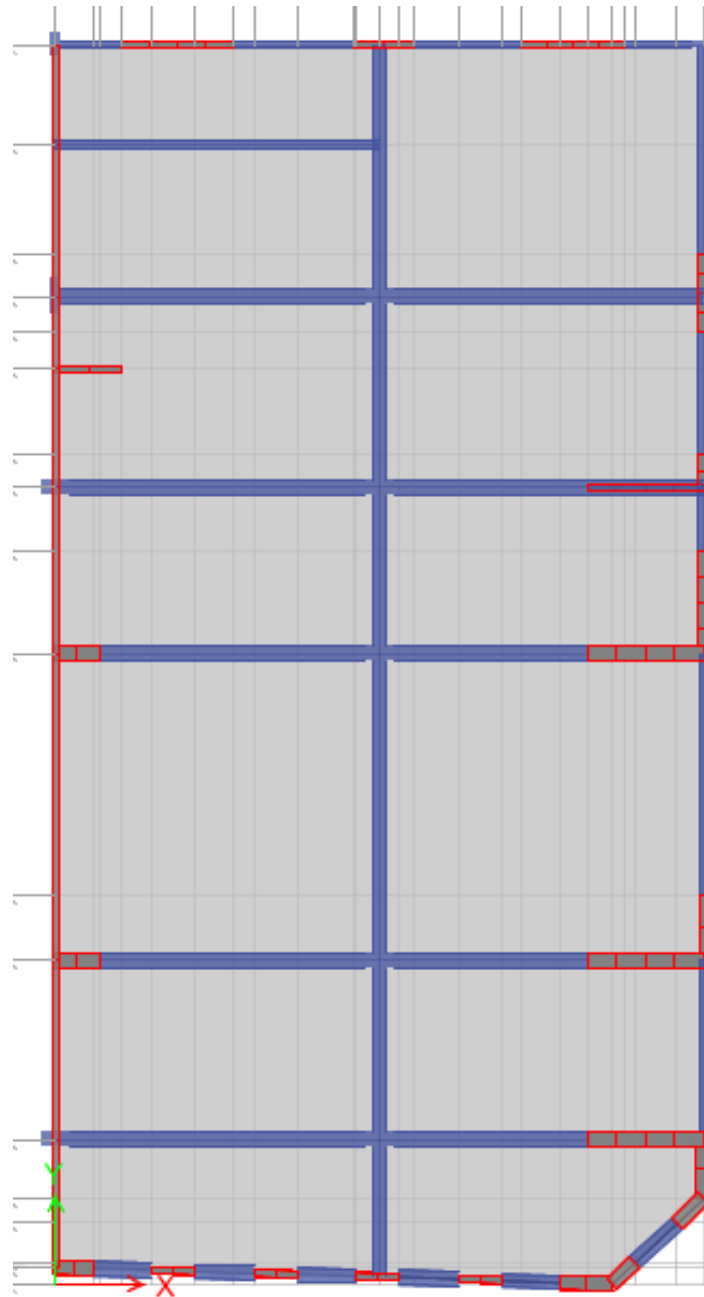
Vista en planta de modelo estructural a evaluar; Fuente: (Elaboración propia)
